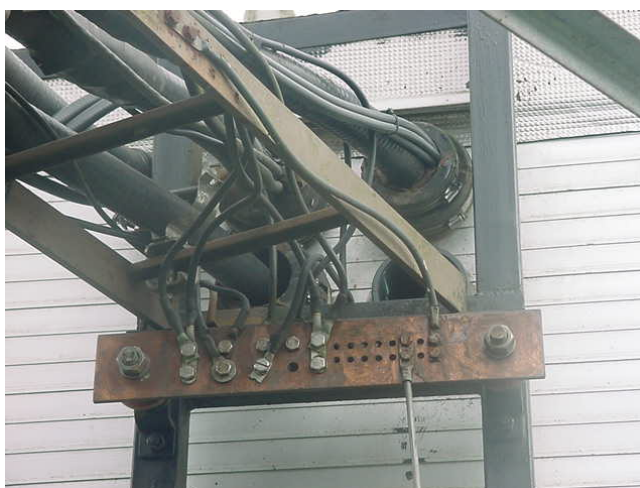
La bandeja sostiene los cables que bajan de la torre a la edificación.
